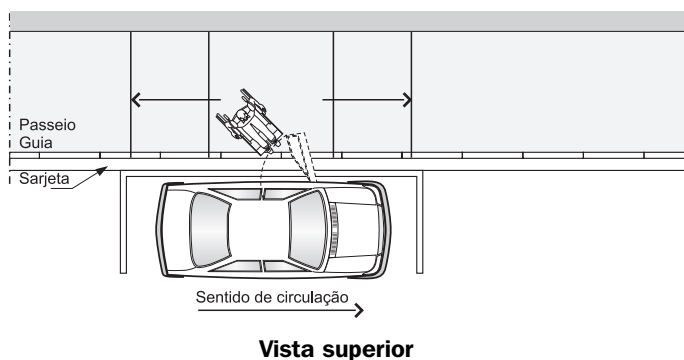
Vagas para estacionamento junto a passeio rebaixado
